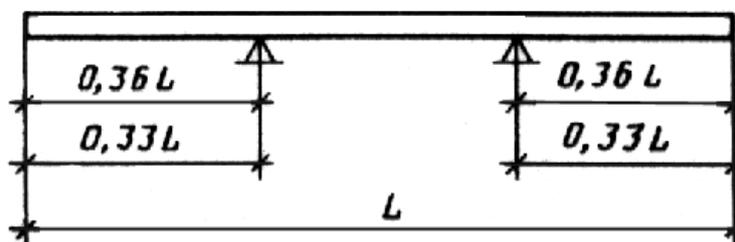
Схема испытания свай на трещиностойкость
